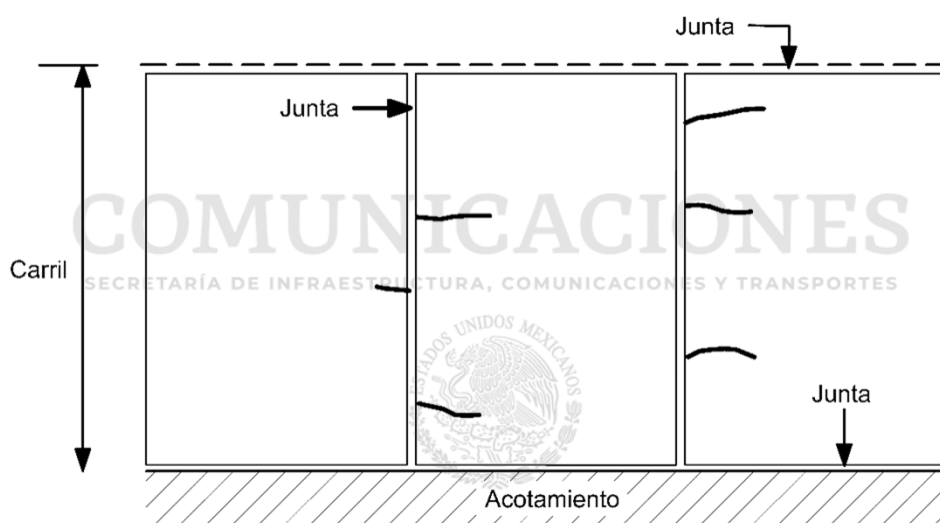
Esquema del deterioro “grietas por retracción” (vista en planta)
